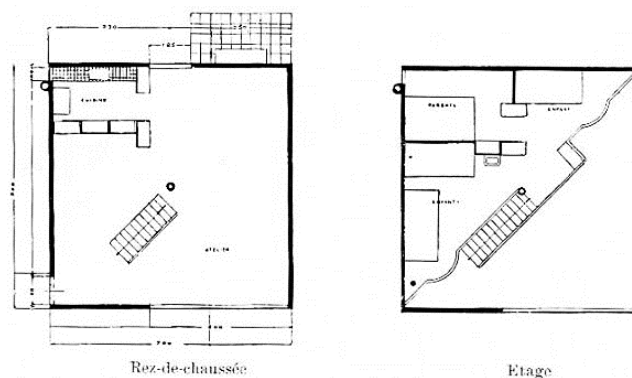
Planta baja de Casas en Serie para artesanos.
